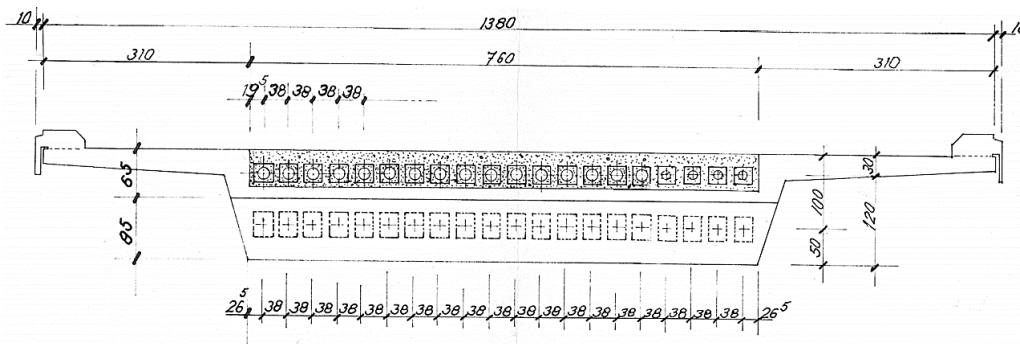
Sezione trasversale, posizionamento degli ancoraggi dei cavi da precompressione
